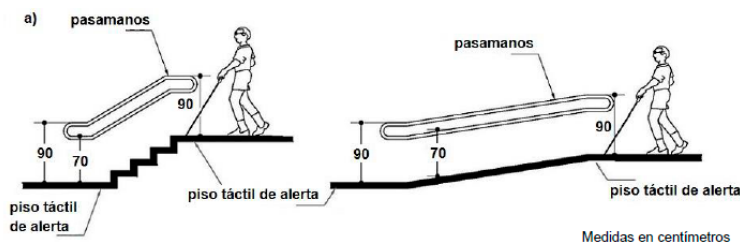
a) Vista en elevación lateral de una escalera y una rampa con respectivas alturas de los pasamanos empotrados a la pared
